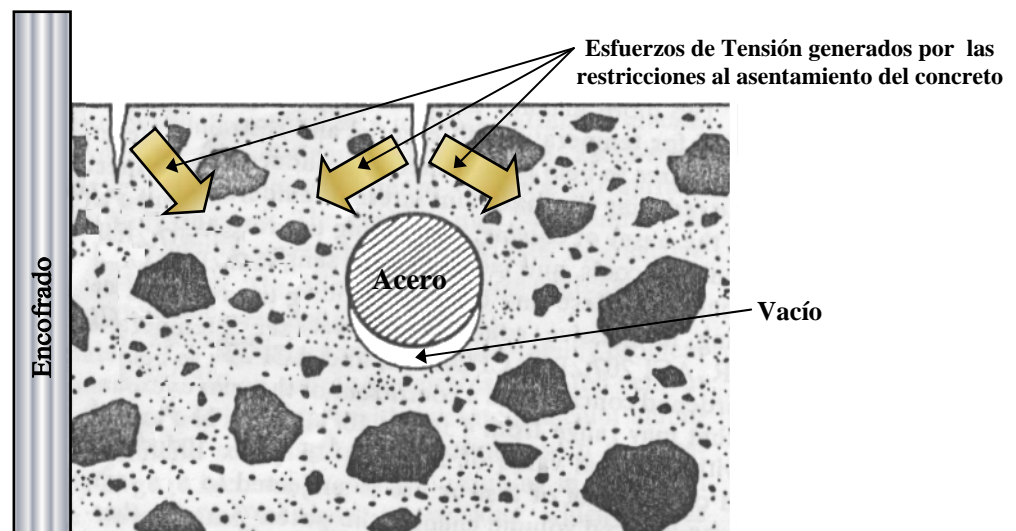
Grietas por Asentamiento Plástico.
